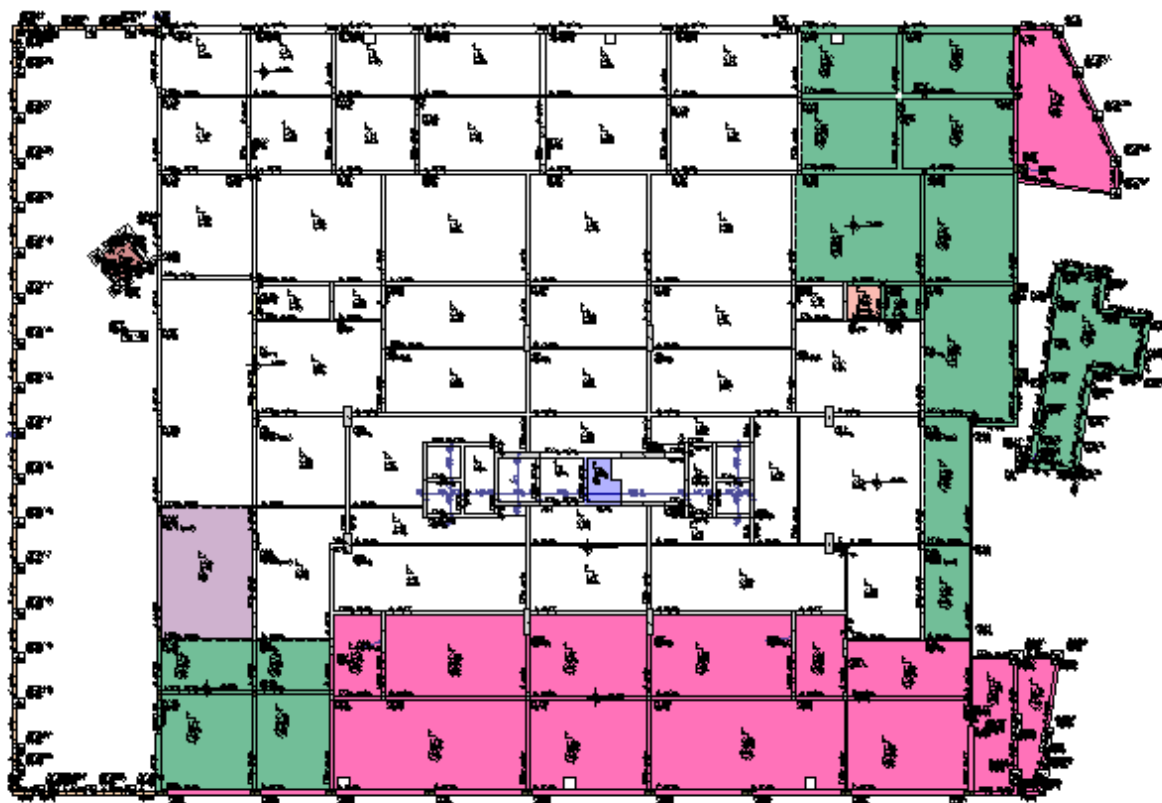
Fôrma do pavimento térreo - opção com laje maciça.
